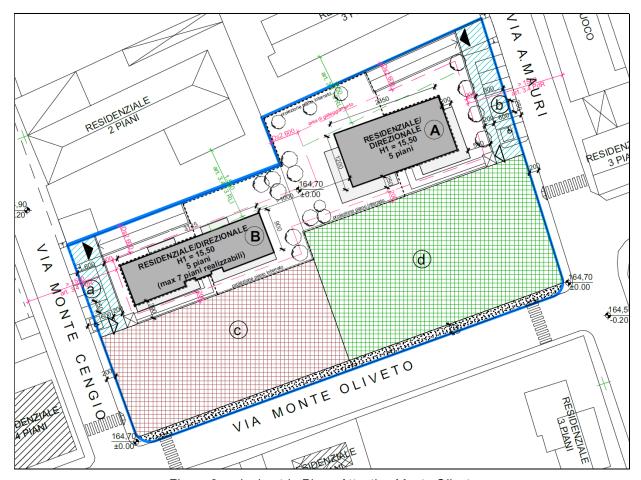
planimetria Piano Attuativo Monte Oliveto
